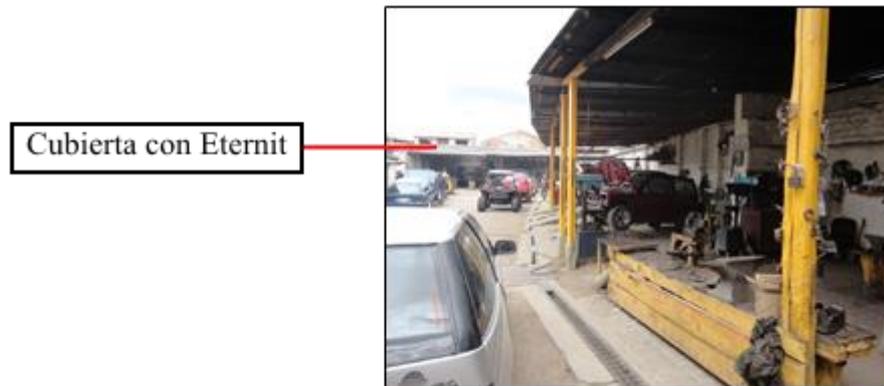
Cubiertas en las zonas de trabajo del taller
